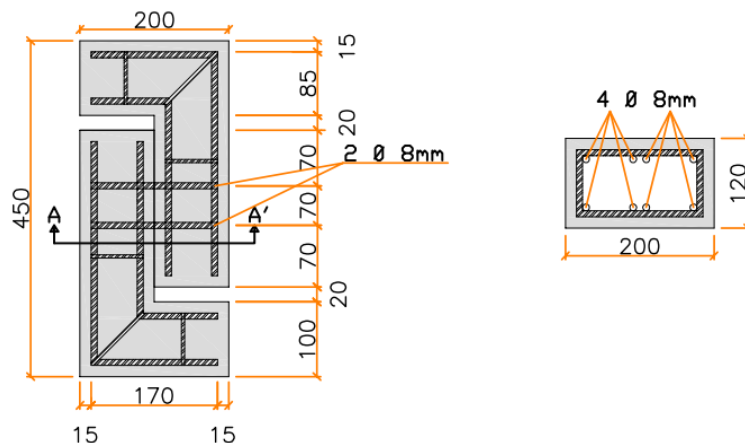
Detalhamento dos corpos de prova com 2 estribos de 8 mm.
